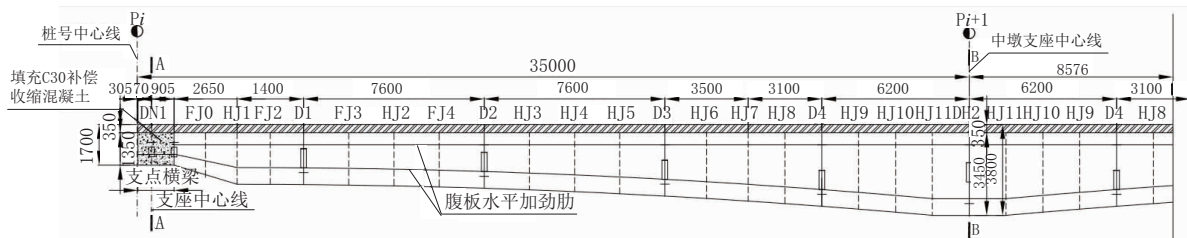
钢-混叠合梁桥纵断面图(单位:mm)
